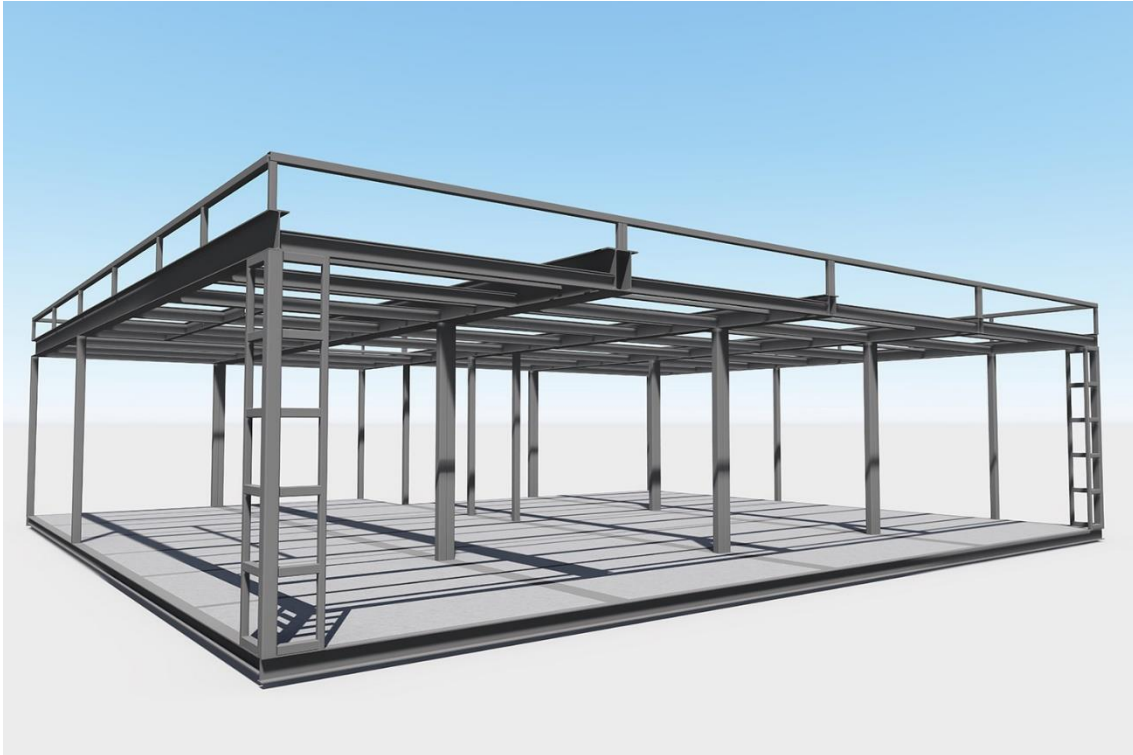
Estructura de acero. Fuente: Empresa Hauss Modular.
